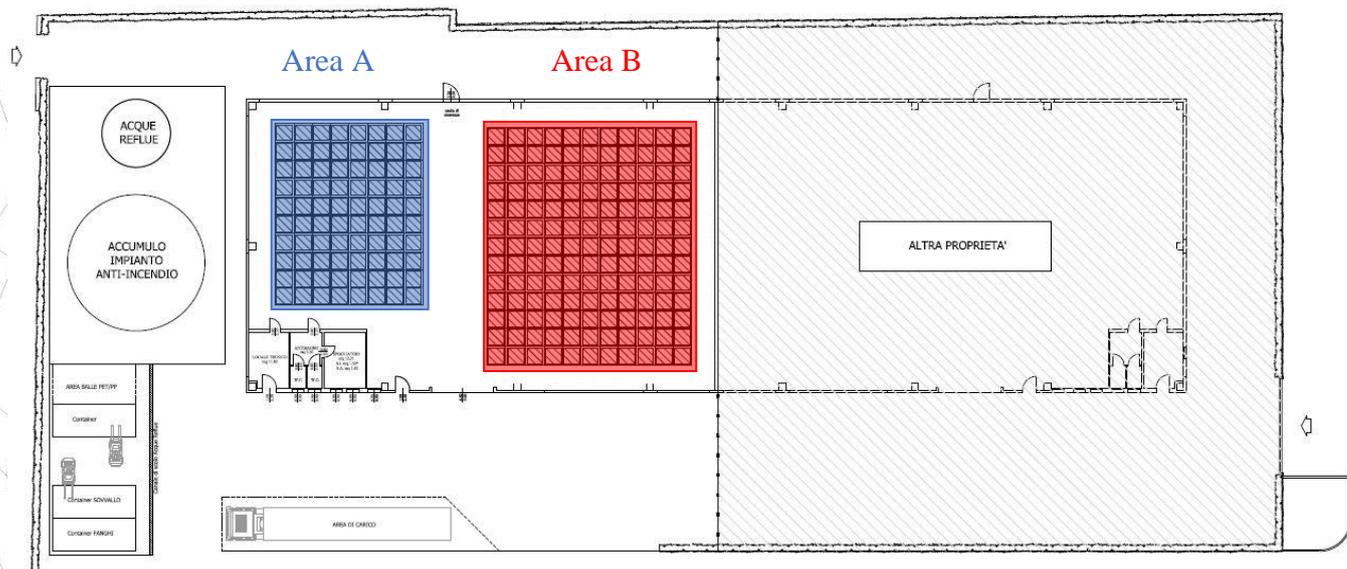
Planimetria dell'edificio con l'indicazione delle aree di stoccaggio (aree A e B).
